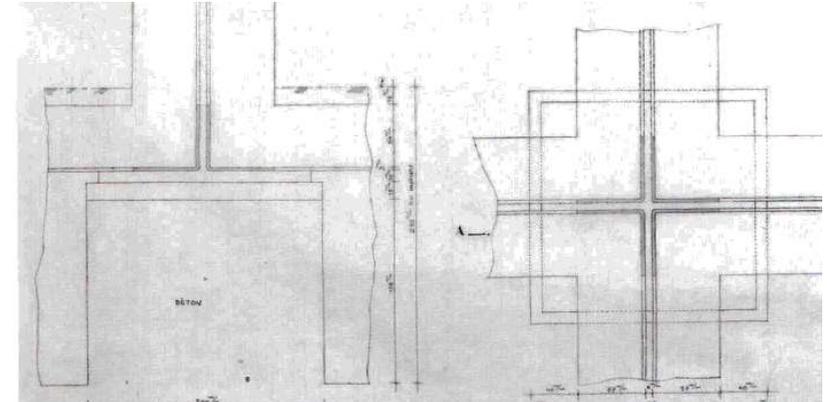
Plano de apoyo de la estructura.plano n° 140,19 de julio de 1966.
